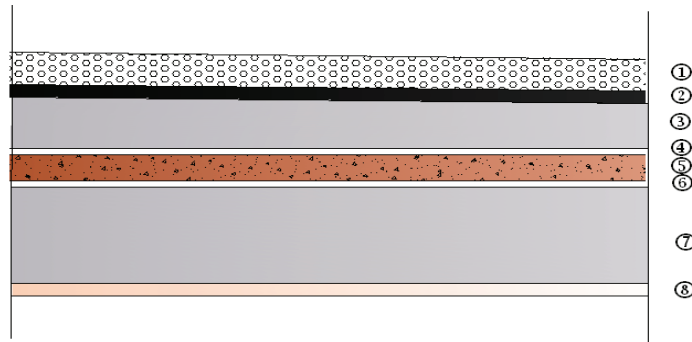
Coupe d'un plancher terrasse en dalle pleine.
